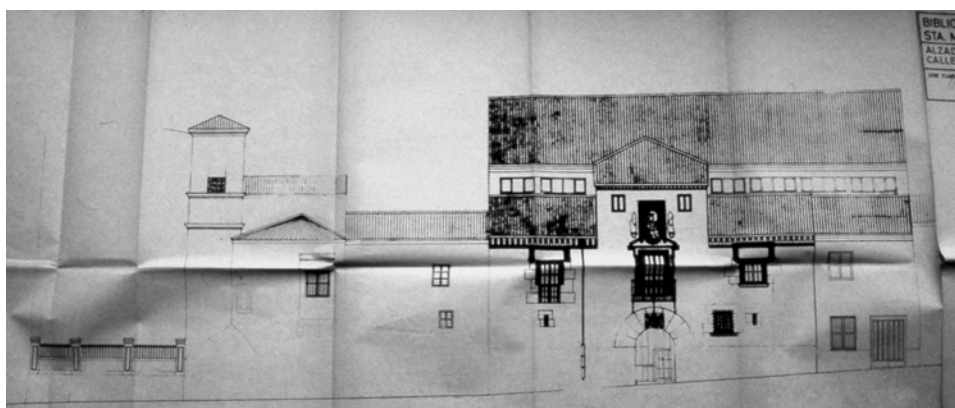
Biblioteca de Santa María de los Ángeles: fachada a calle Libreros, por J. E. Díez y R. Pérez, septiembre de 1982.
